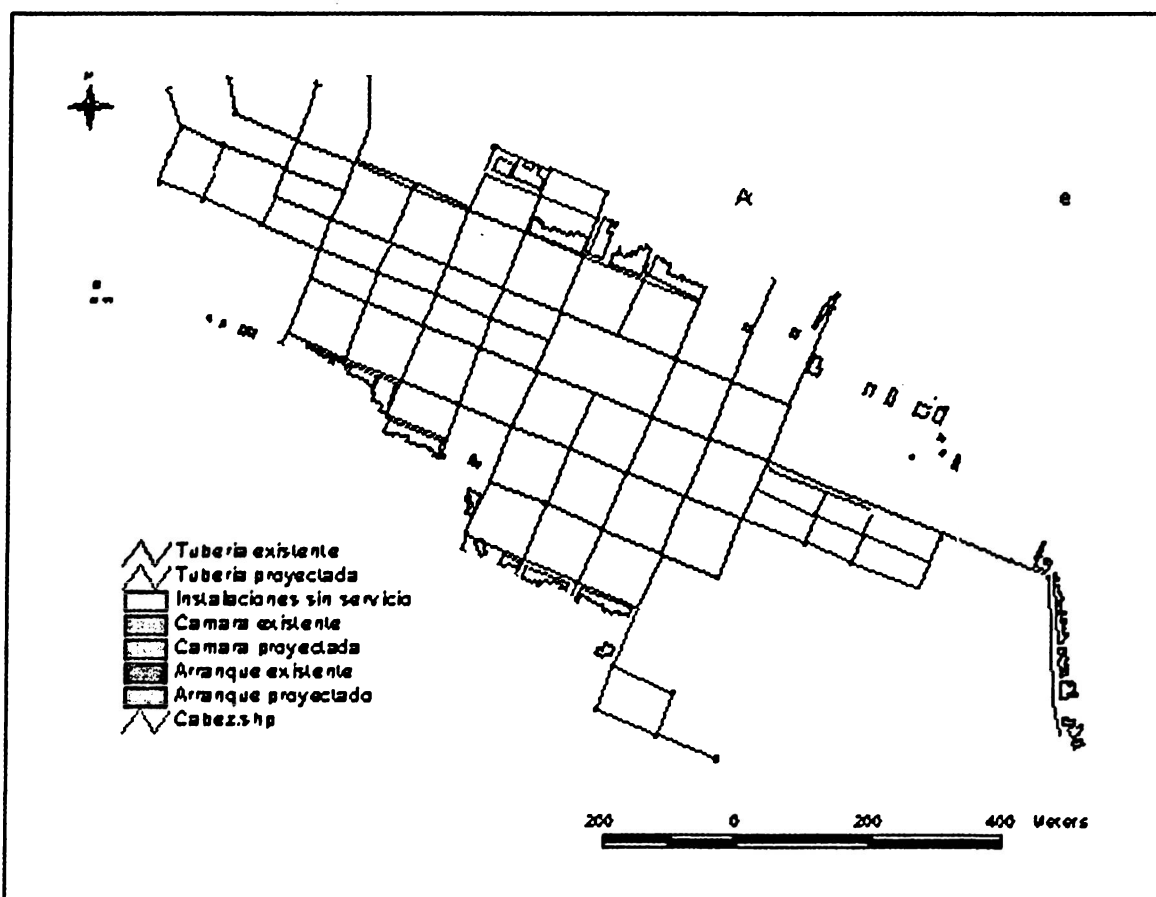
Alcantarillado Municipal, Municipio de Jardín. Estado Actual.
